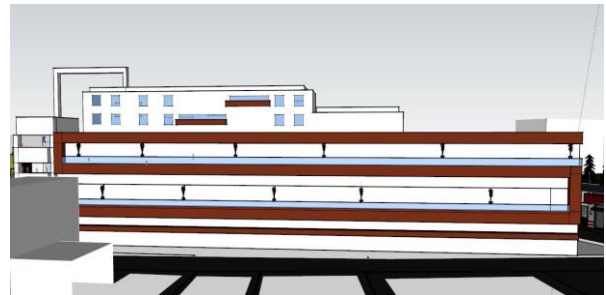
Vue sur proposition d'intervention sur le bâtiment.
